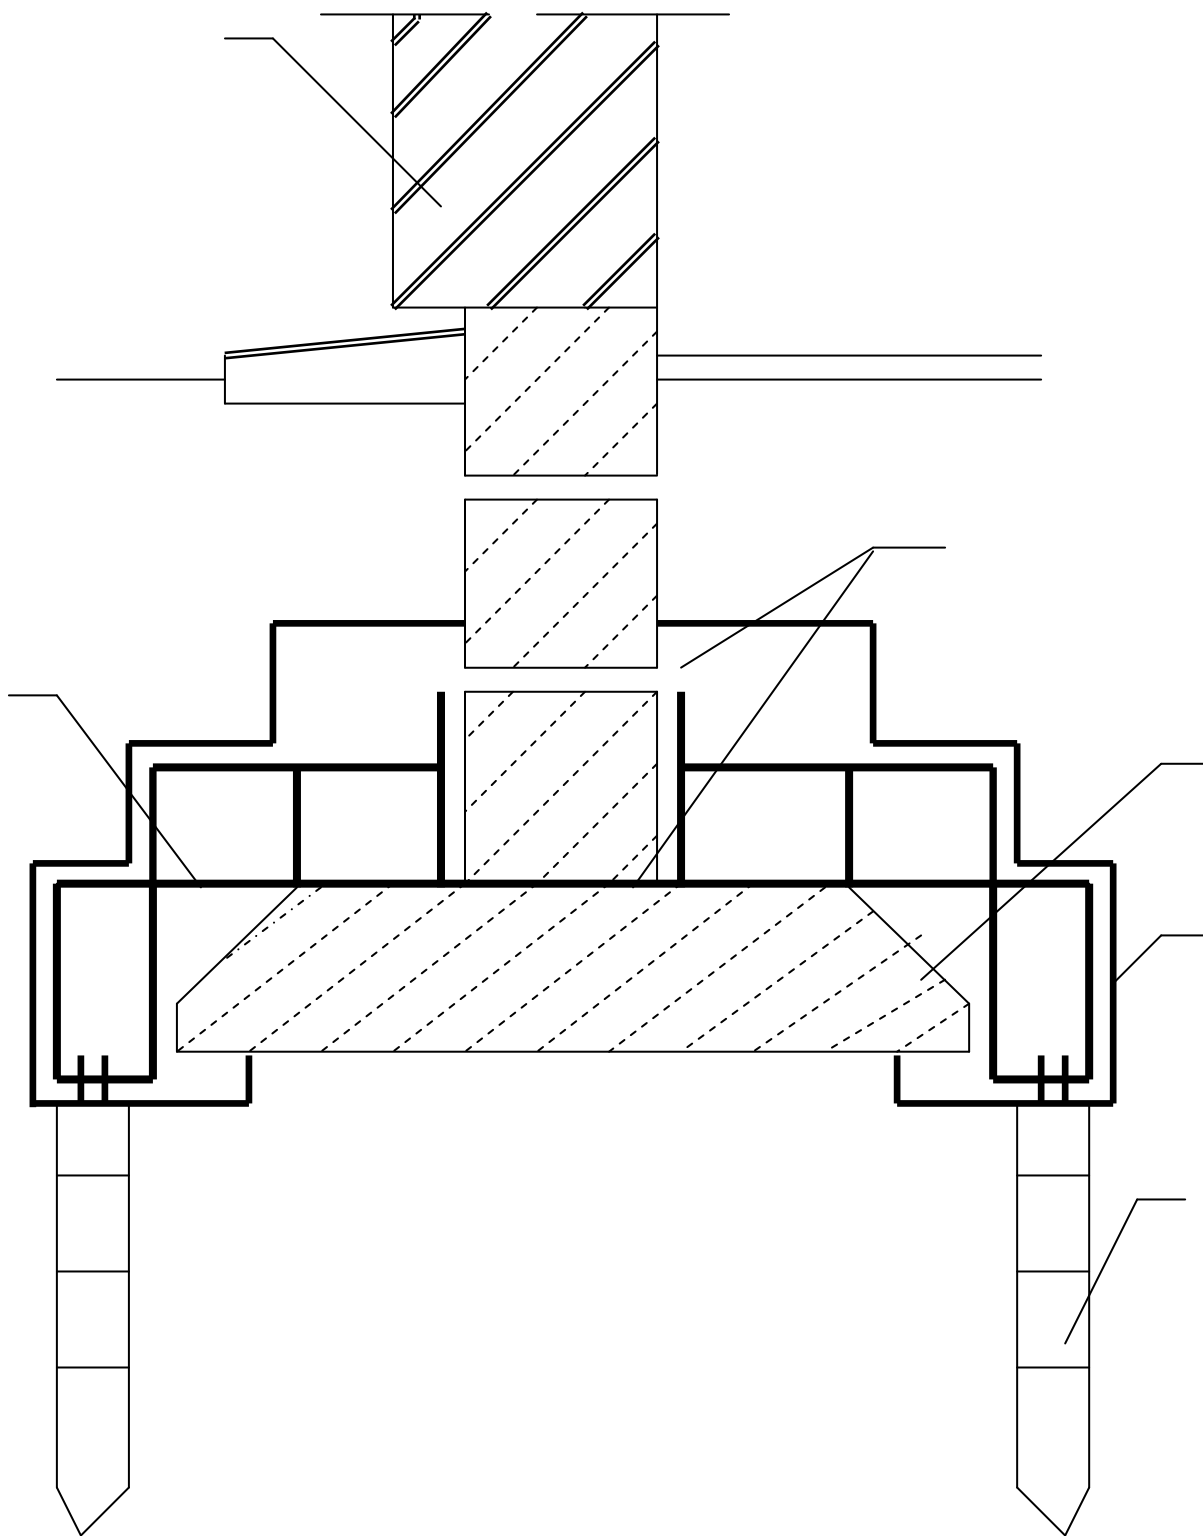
Передача нагрузки от стены на короткие составные сваи, погружаемые задавливанием
